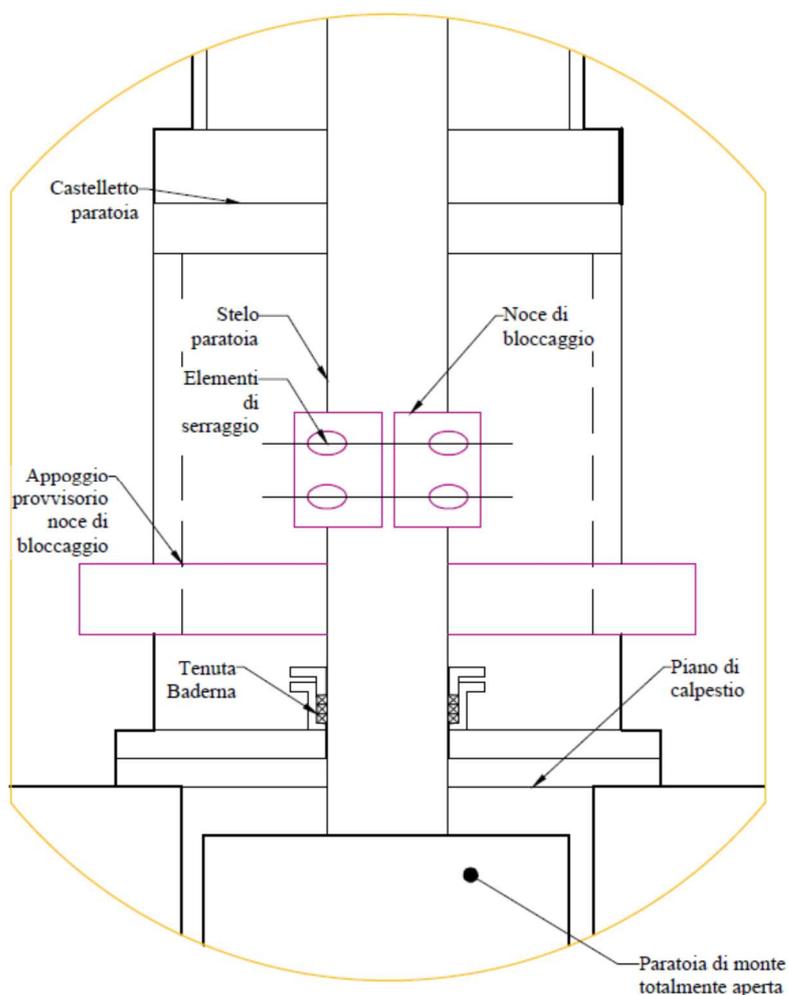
Stralcio sezione del pozzo paratoie e dettaglio della noce di bloccaggio
